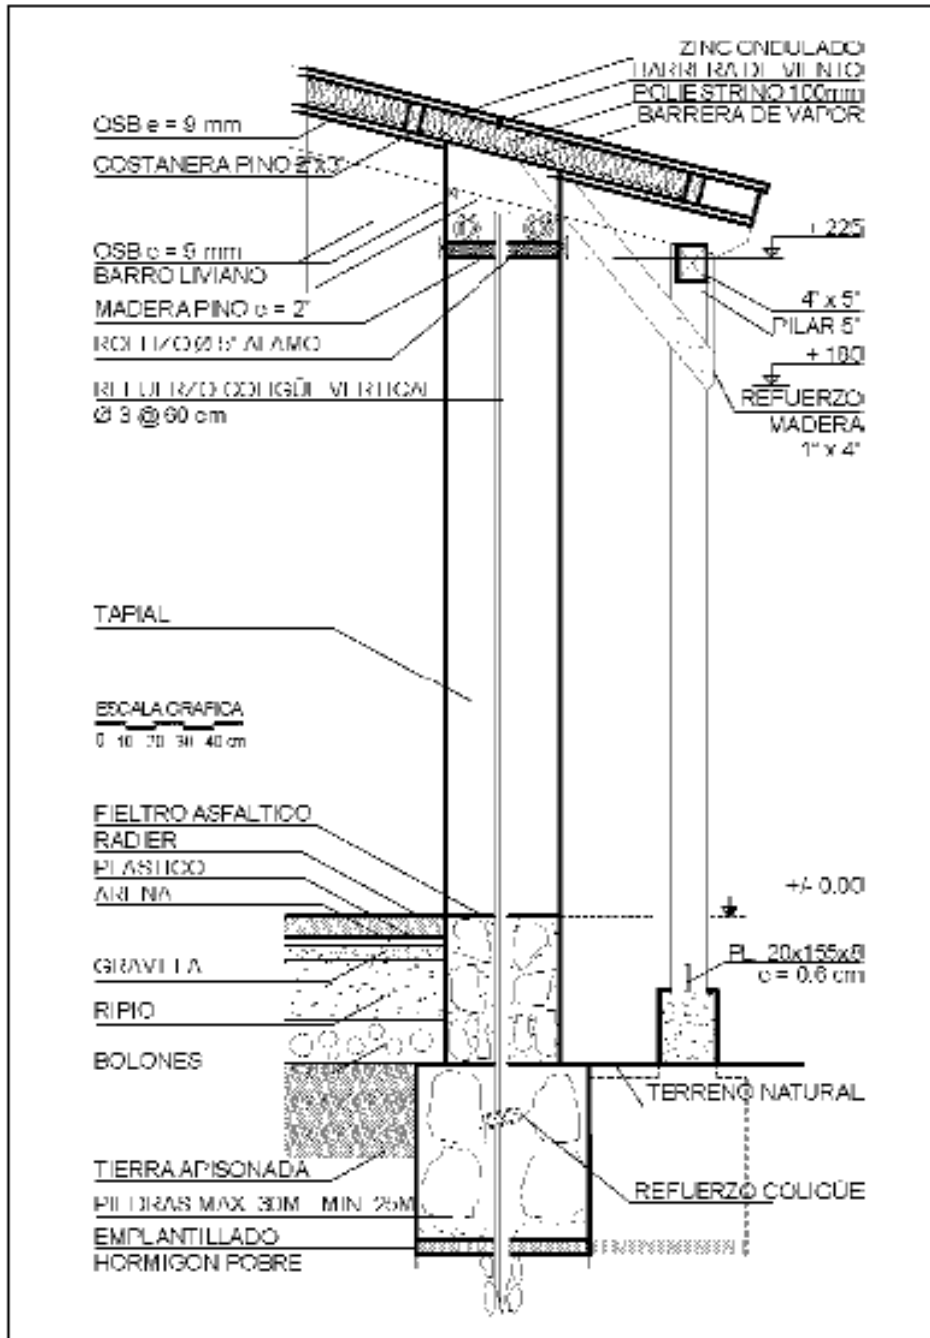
y 3-48 Propuestas para viviendas con cubiertas aisladas.
